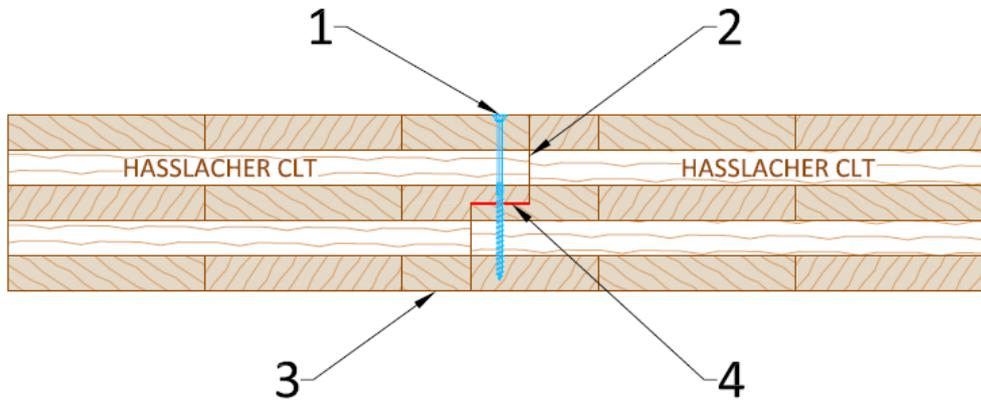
Coupe horizontale, jonction de planchers par assemblage à mi-bois
